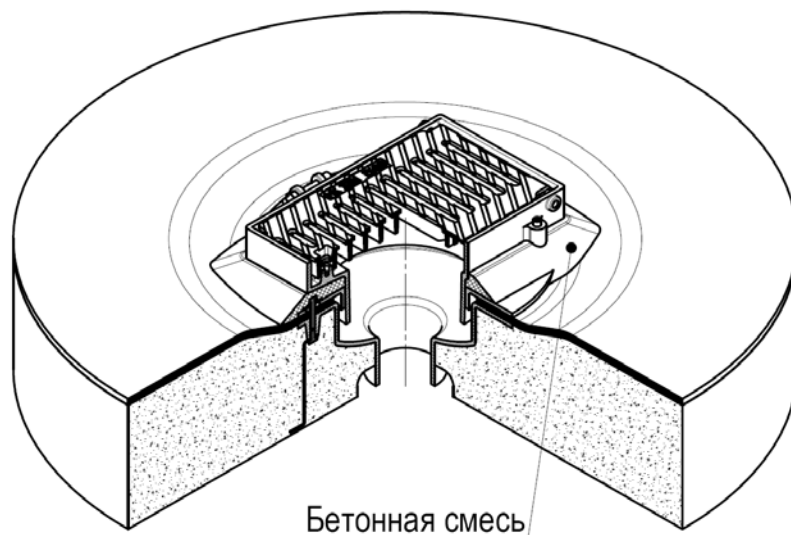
Установка верхнего корпуса трапа мостового ж/б 340x530
